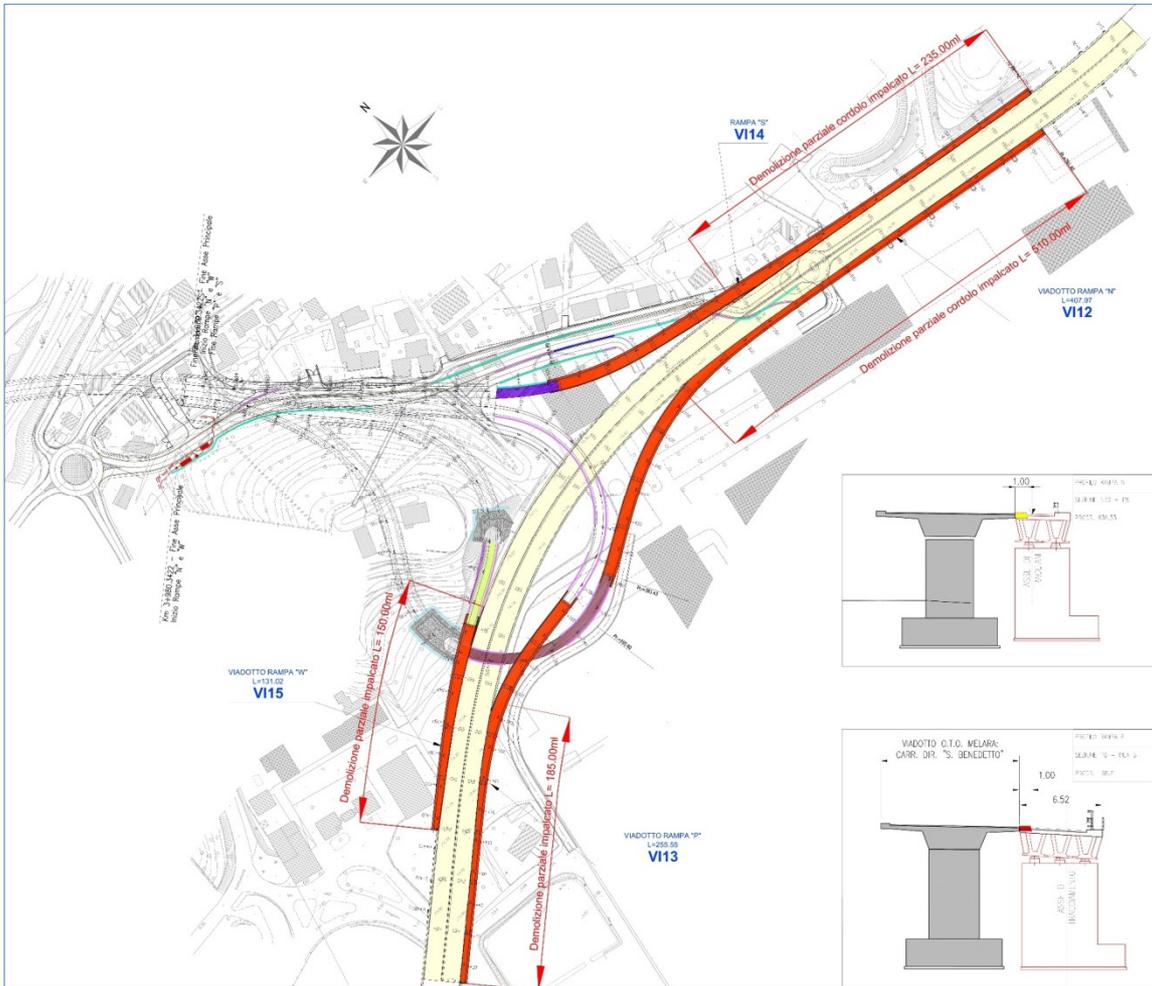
Viadotti Svincolo Melara – Stralcio planimetrico
